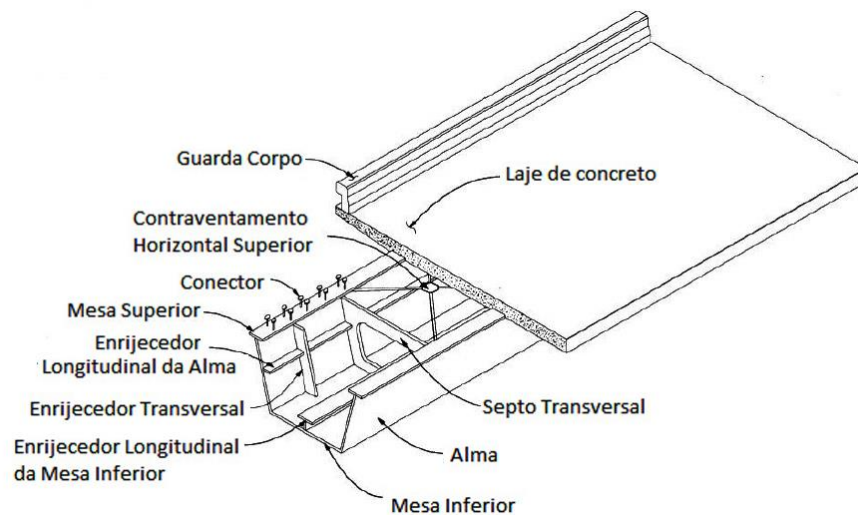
Componentes de um típico tabuleiro misto em caixaão. (Adaptado de Saleh e Duan, 2000)
